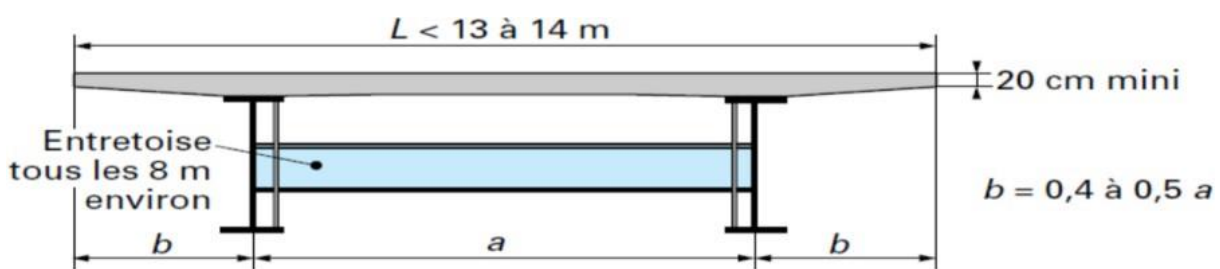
Profil en travers d'un pont bipoutre à entretoises
